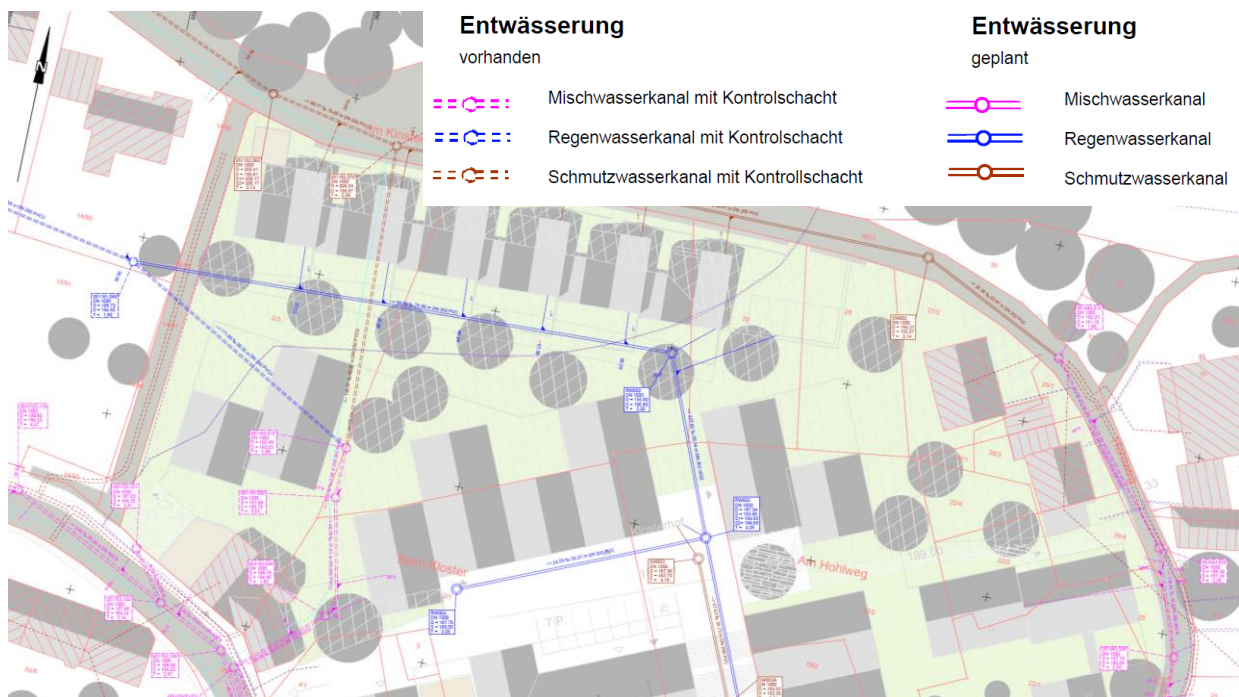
geplanter Verlauf Regenwasserkanal (durchgezogene blaue Linie) und zurückzubauender Regenwasserkanal (gestrichelte blaue Linie)
